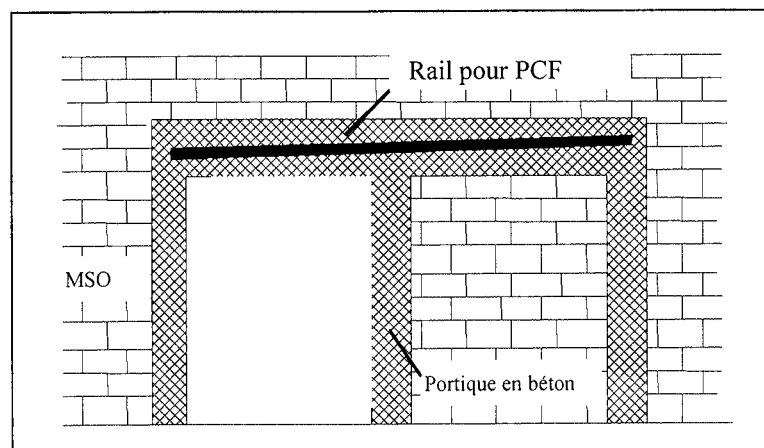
b. : Mise en place d'une porte coupe-feu.
